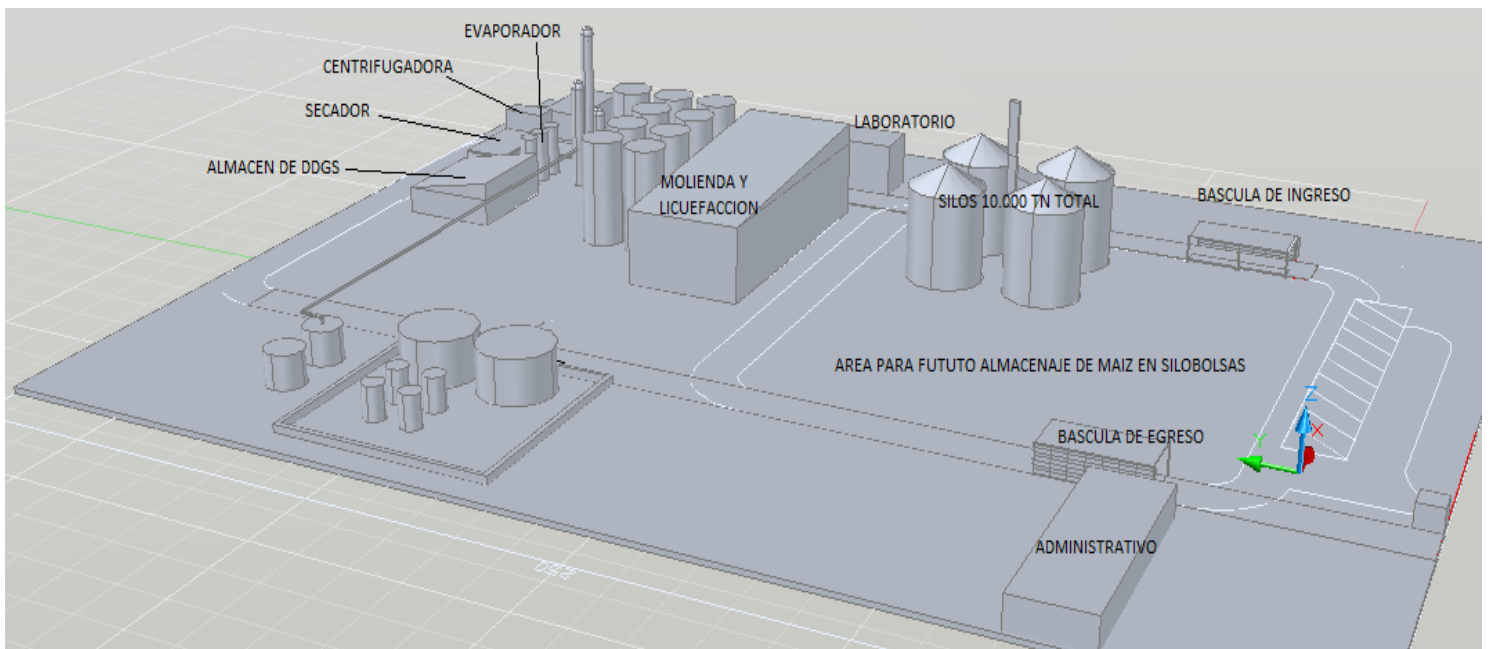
Vista anterior de la planta con ingreso, egreso y sectores de estacionamiento.
